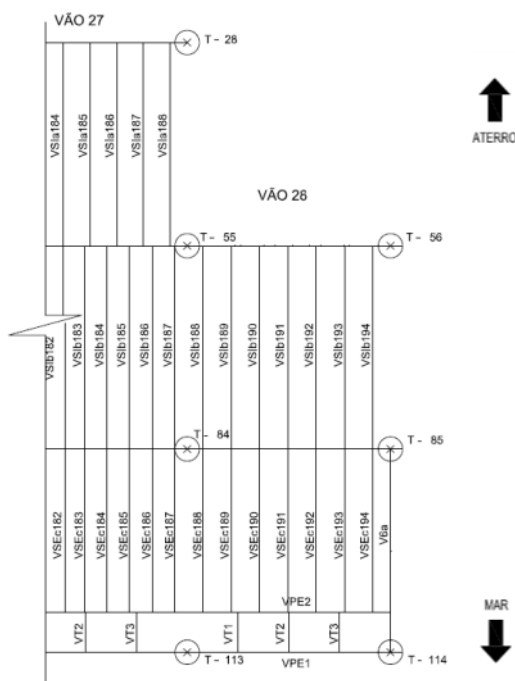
Planta do Berço 103 entre Vãos 27 e 28
